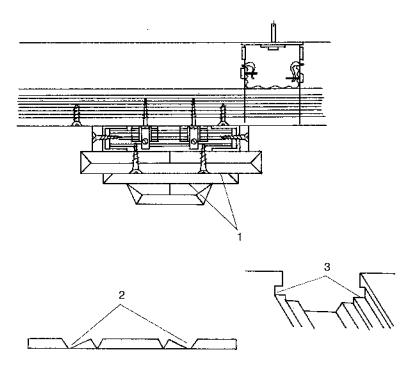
Схема ступенчатого потолка из гипсокартонных элементов: 1— соединение гипсокартонных пластин; 2— развертка; 3— профиль
